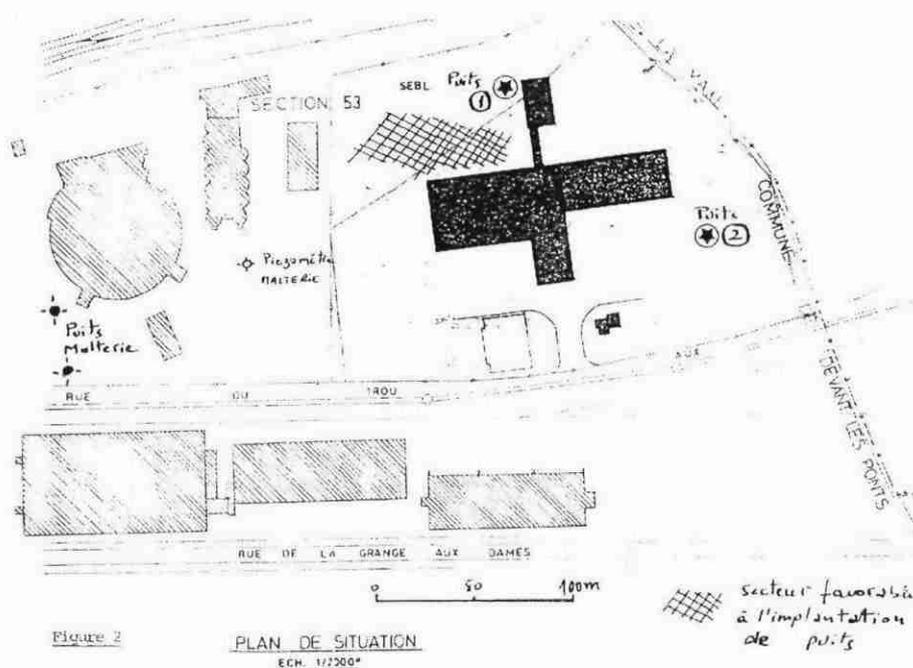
Plans du site SICADIME et implantation des puits (D'après BRGM 1989)
